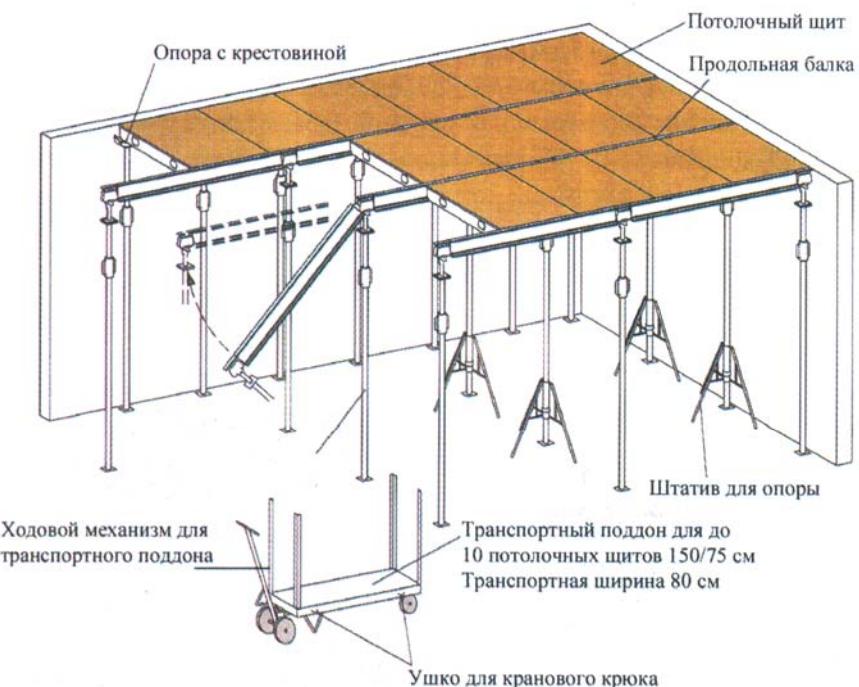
Опалубка перекрытий фирмы «НОЕ» с несущими элементами из алюминиевых сплавов
